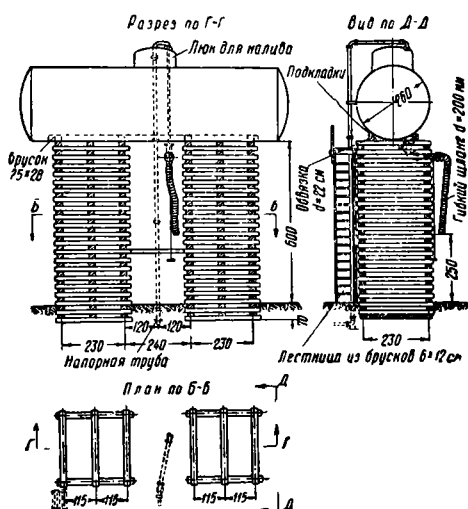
Временное водоснабжение с паровым оборудованием при заборе грунтовых вод
